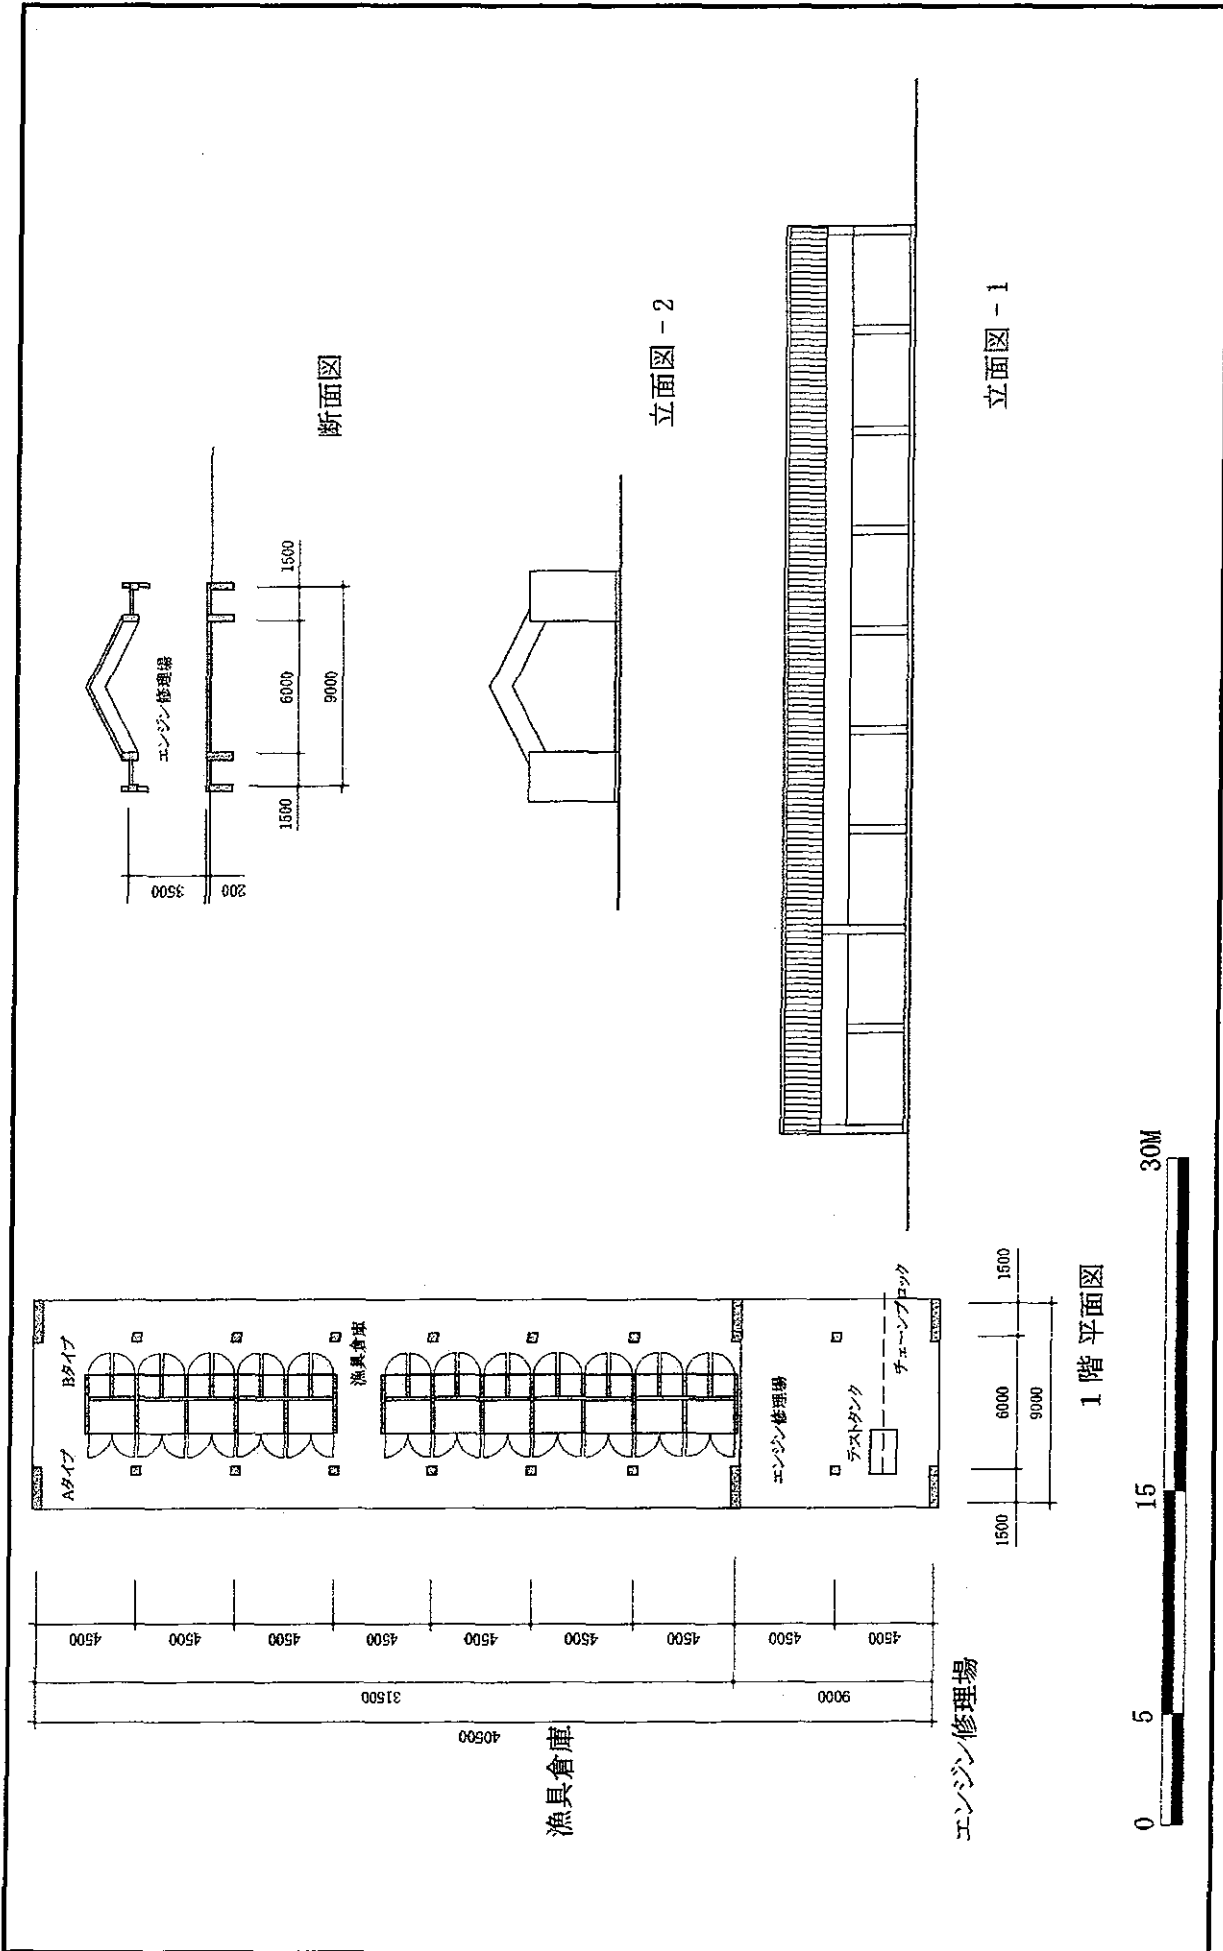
(10) エンジン修理場・漁具倉庫棟平面図・立面図・断面図
